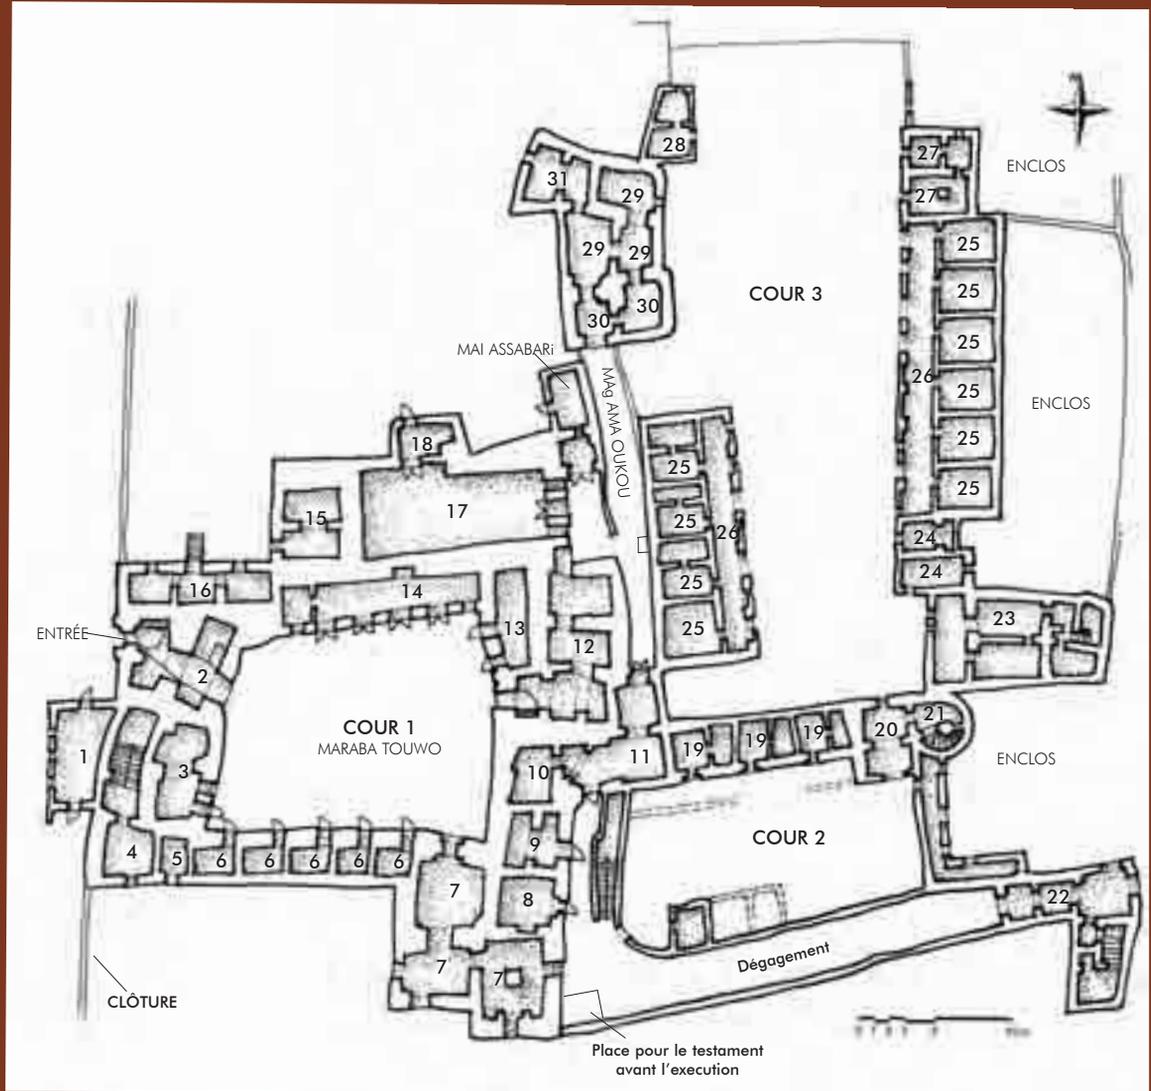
Plan du rez de chaussée et façade Ouest avec entrée du Palais.
